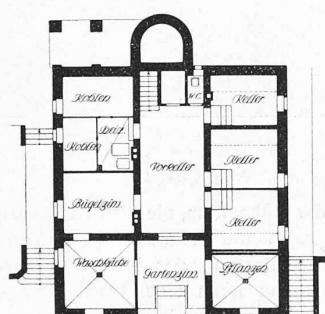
bis 5. Grundrisse vom Untergeschoss, Erdgeschoss, 1. Stock und Dachstock. — Maßstab 1:400.
